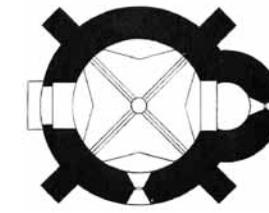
Grundriss Untergreutschach, M 1:200, Kunsttopographie 1889, 81-82.
